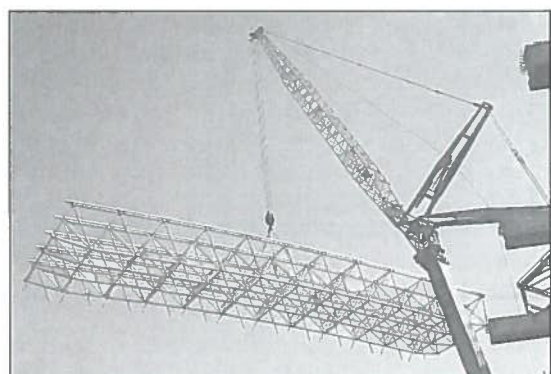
Sollevamento di una porzione prefabbricata di una struttura reticolare spaziale
